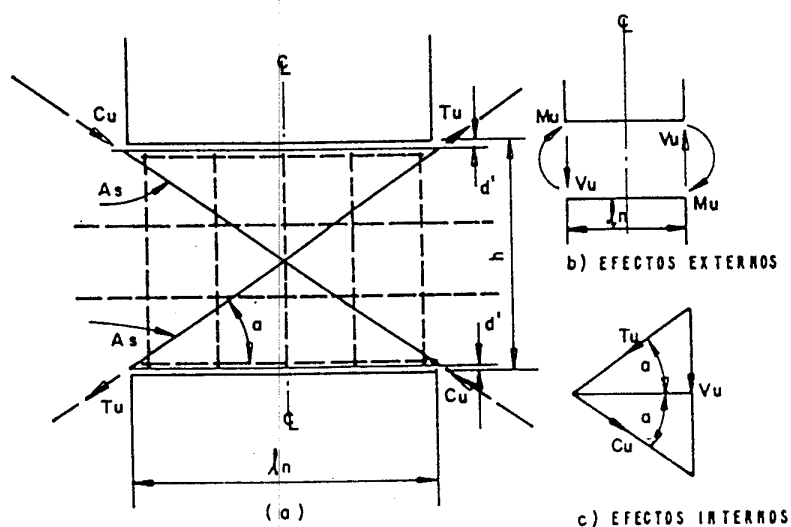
CONSTRUCCION GEOMETRICA DEL REFUERZO DE UNA VIGA DE ACOPLAMIENTO O DINTEL ENTRE MUROS ESTRUCTURALES.
